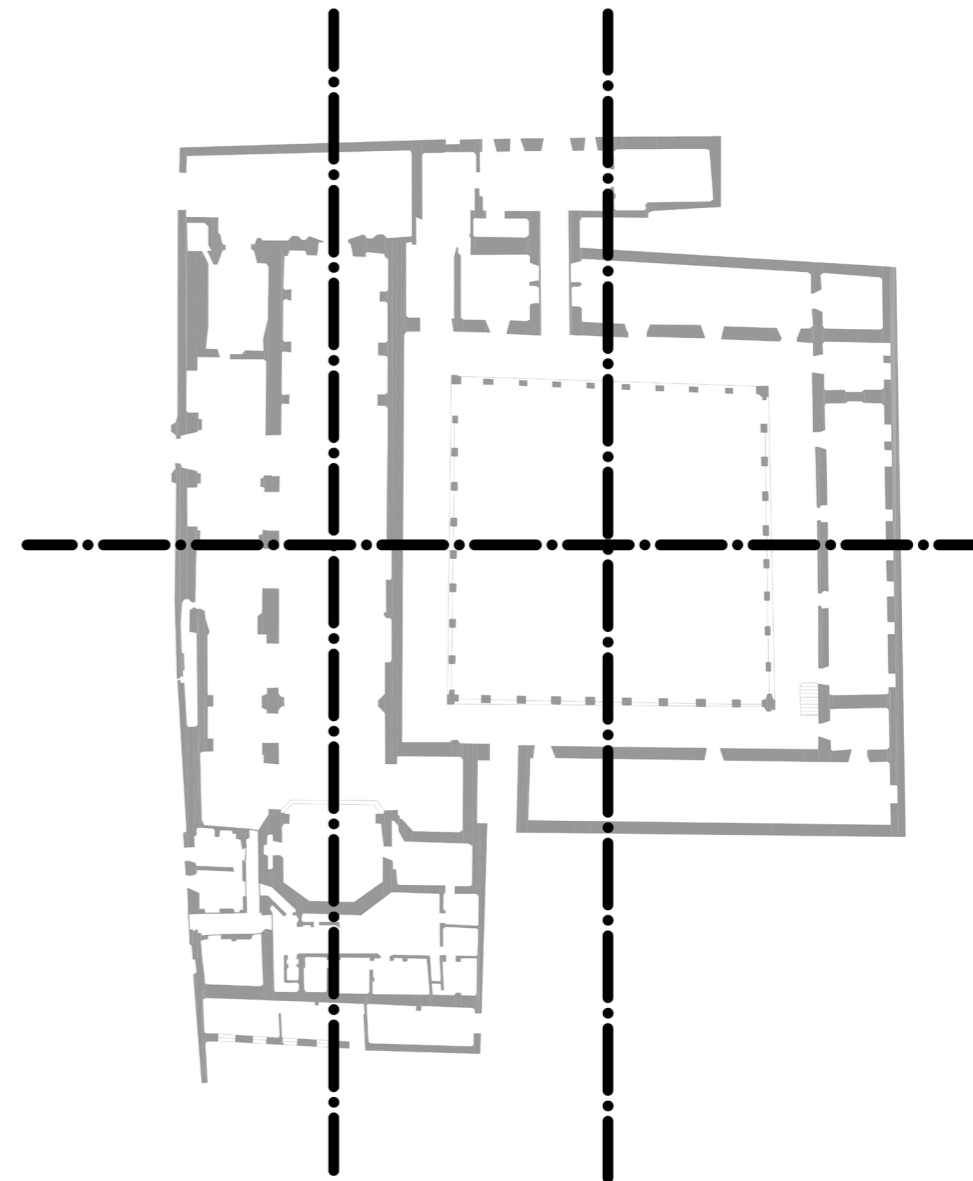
Planta del convento y claustro con ejes. Elaboración propia (2019)
